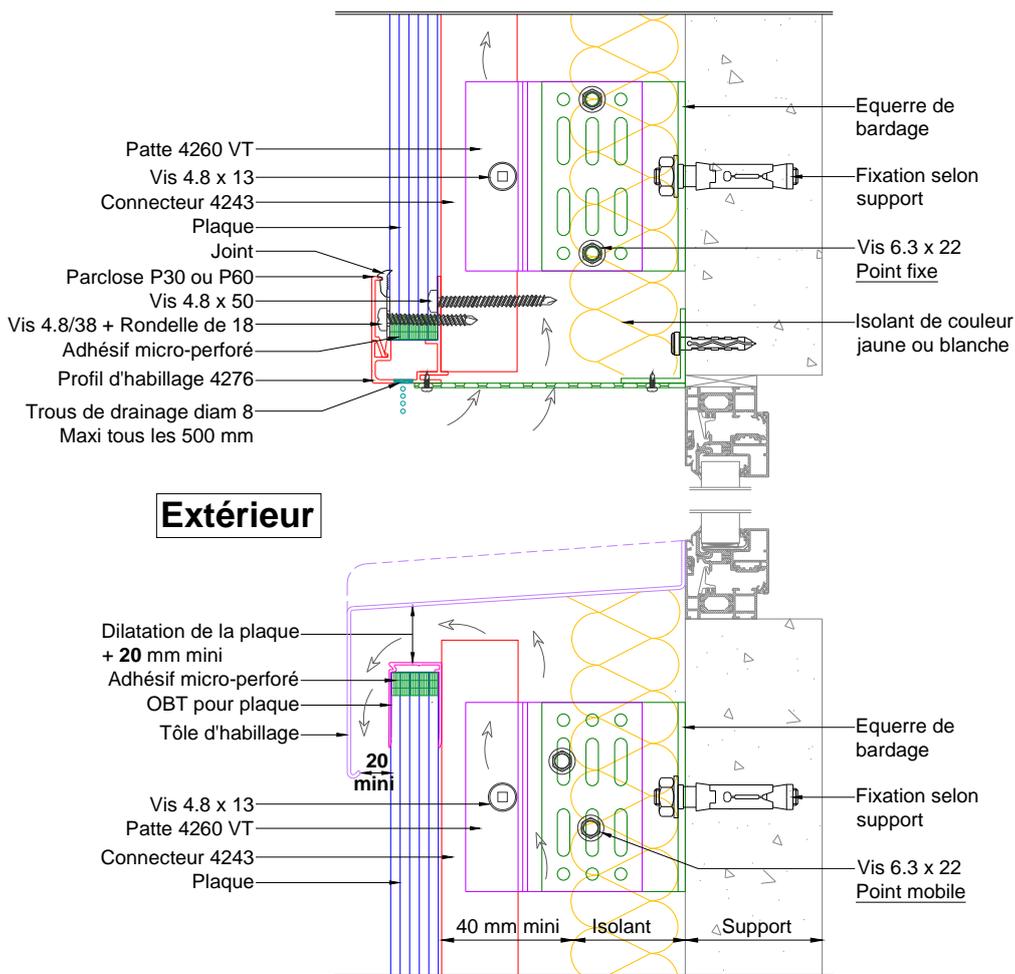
Encadrement d'une baie en tunnel avec plaque entière – Coupe Horizontale
